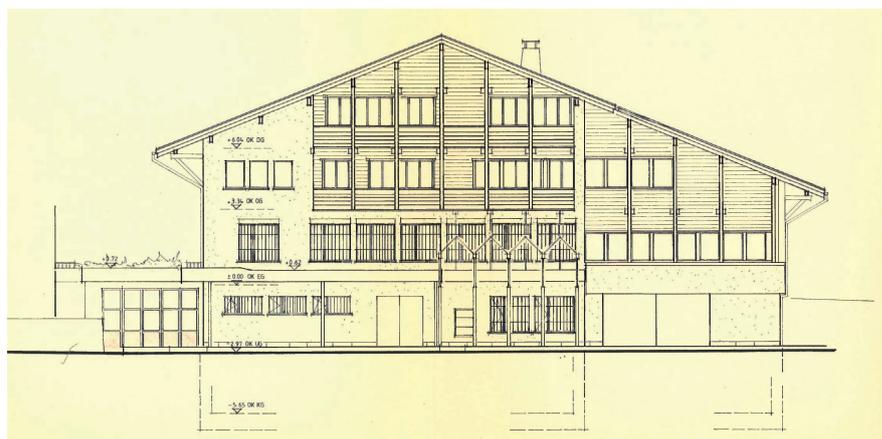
Ansicht Fassade Süd, Ausführungsplan von 1993
